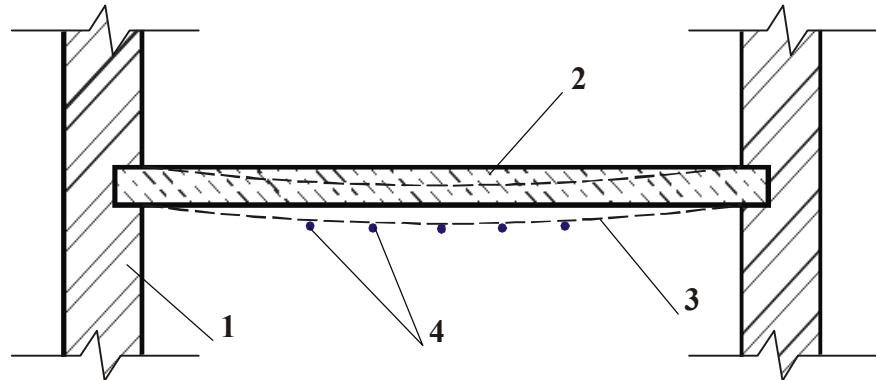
Усунення прогинання залізобетонного перекриття всередині прогону:
